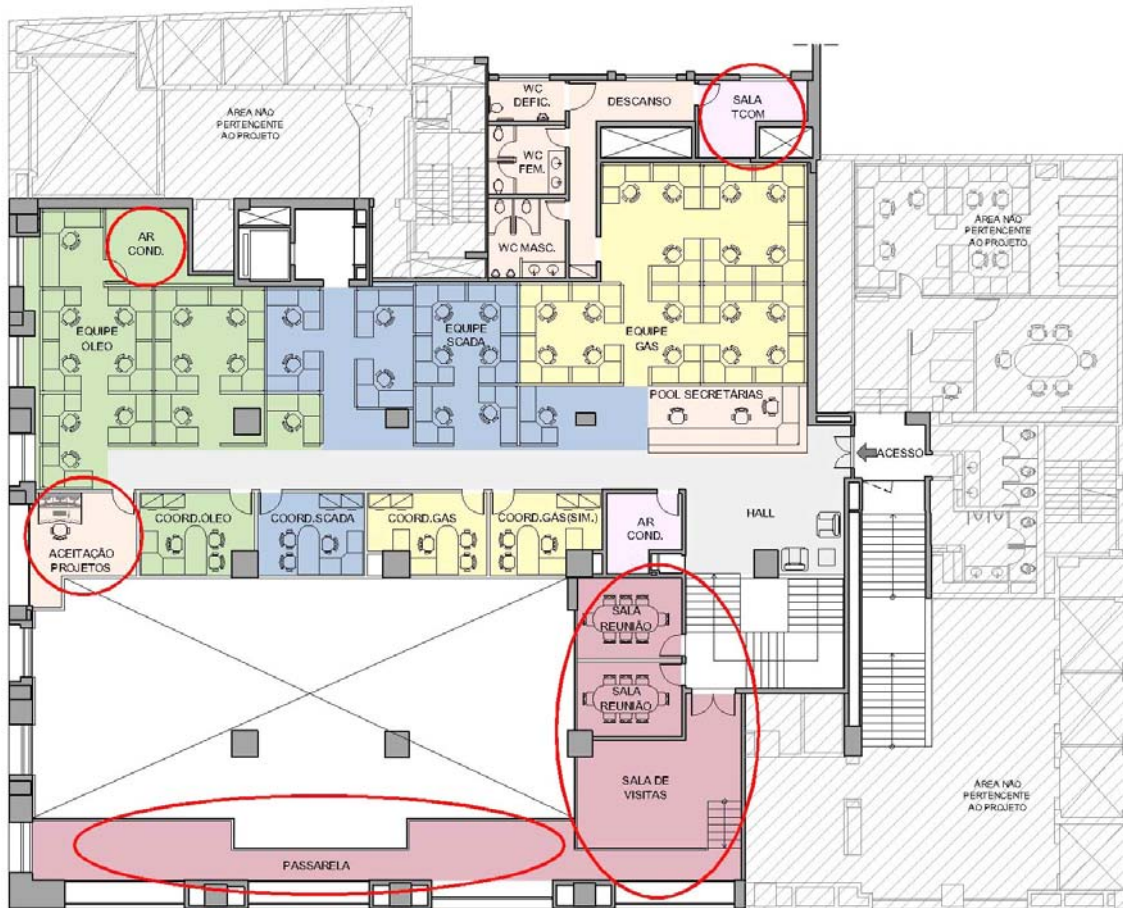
Planta baixa mezanino: opção com as alterações do layout (vinte de junho)
